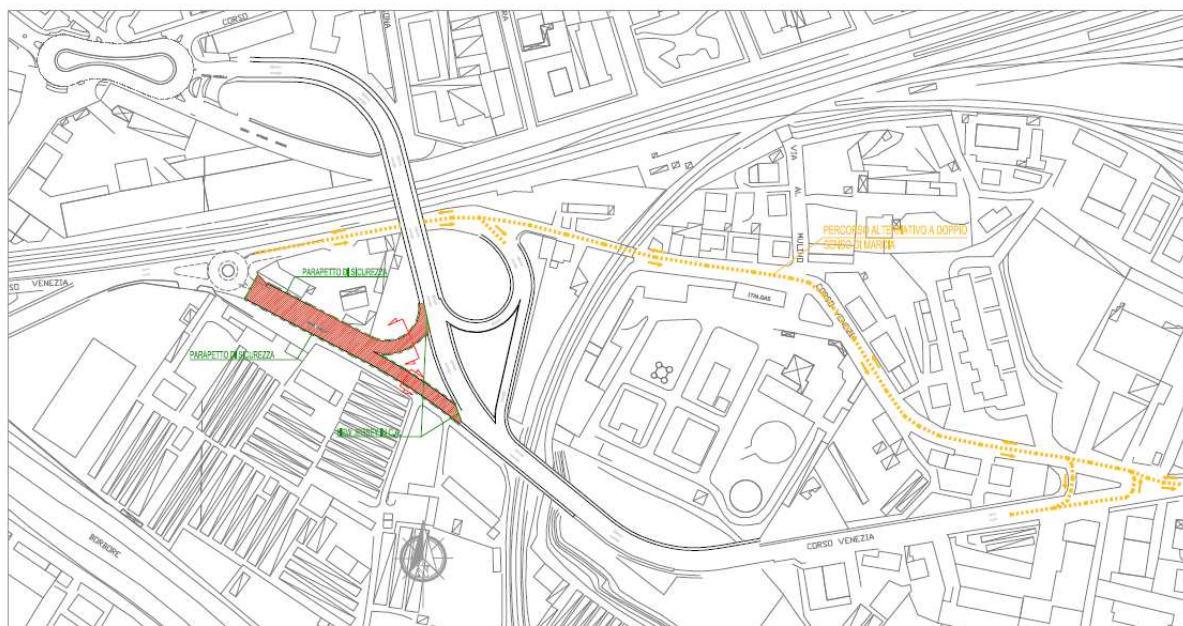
Individuazione dell'area di cantiere, relativamente alla fase 2 b durante le fasi di getto
